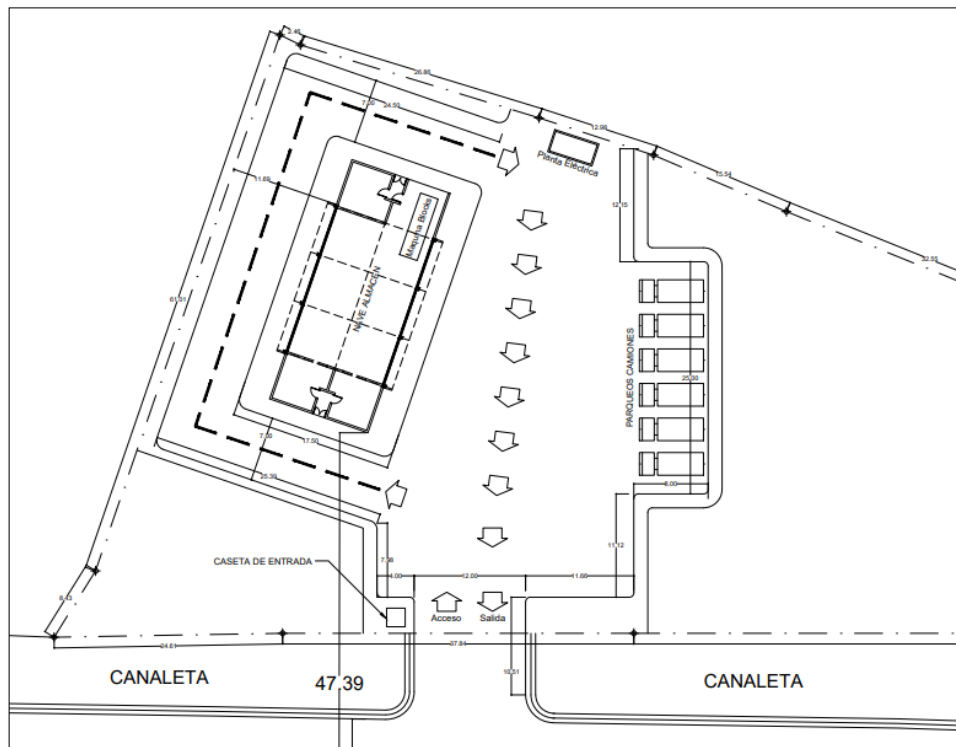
Plano de conjunto del proyecto, se muestra una canaleta o canal realizado para el desagüe pluvial.
